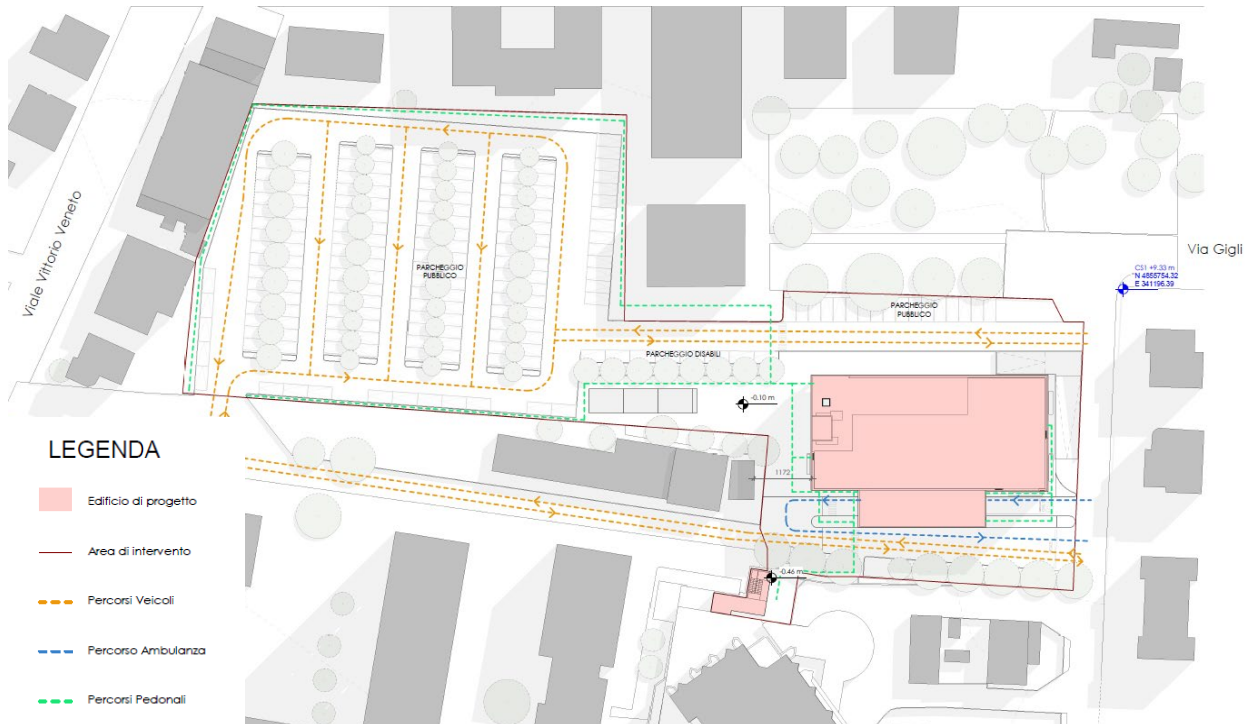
Stralcio Stato di Progetto – Planimetria Generale
